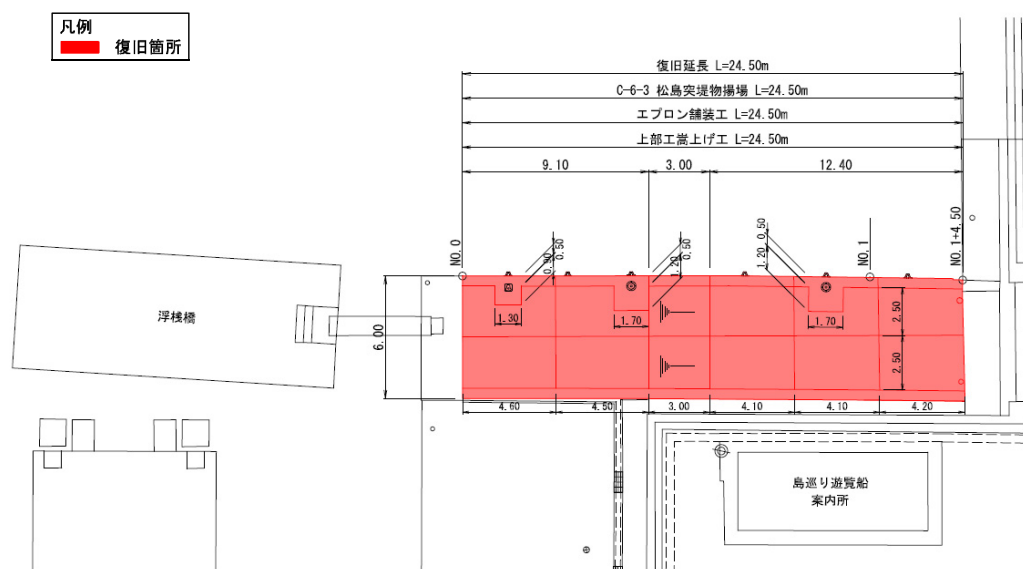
No. 8 松島突堤物揚場の平面図（復旧後）
